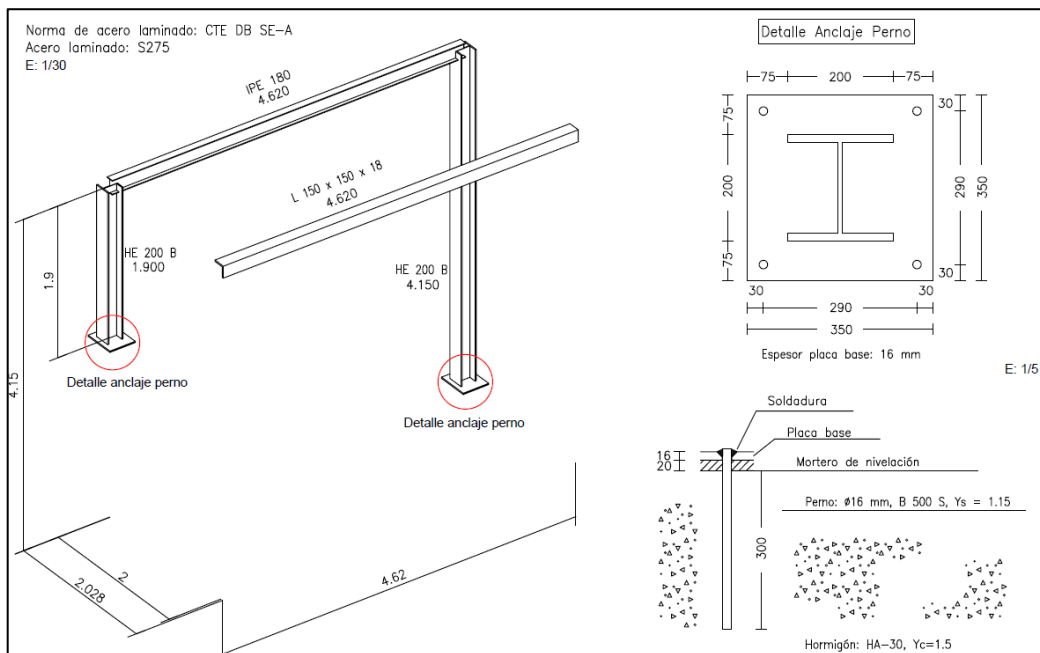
Esquema de la estructura junto con el anclaje al suelo
